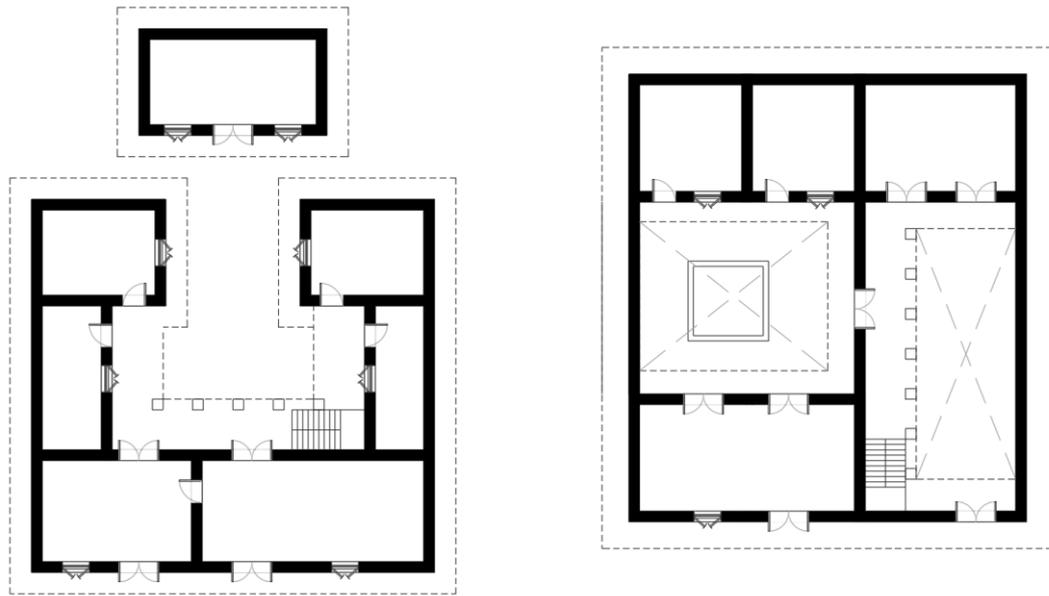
Disposición de Planta de casas tipo patio y retablo.
